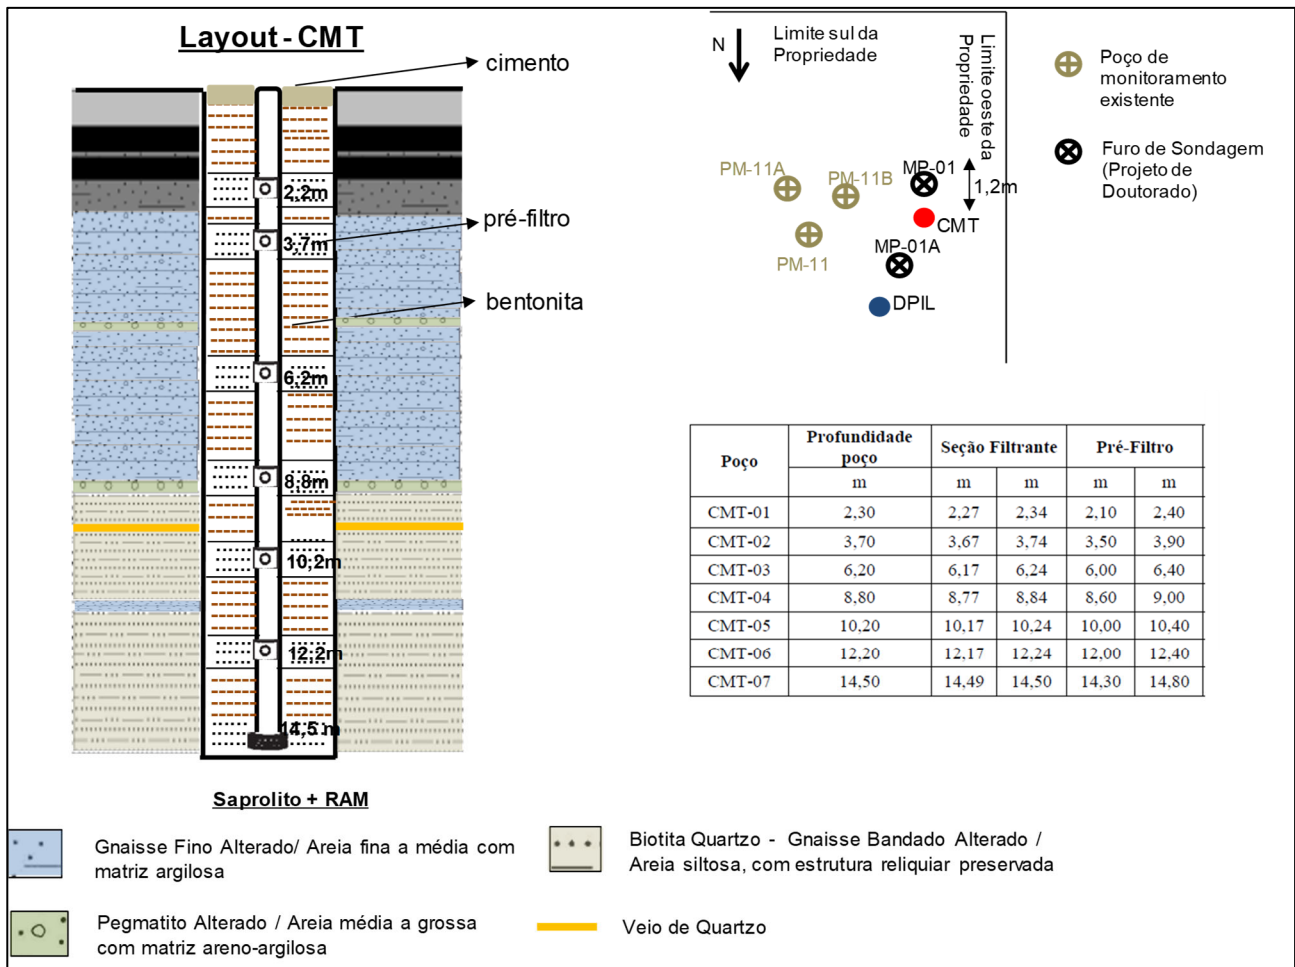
Perfil Construtivo do poço CMT e sua localização.
